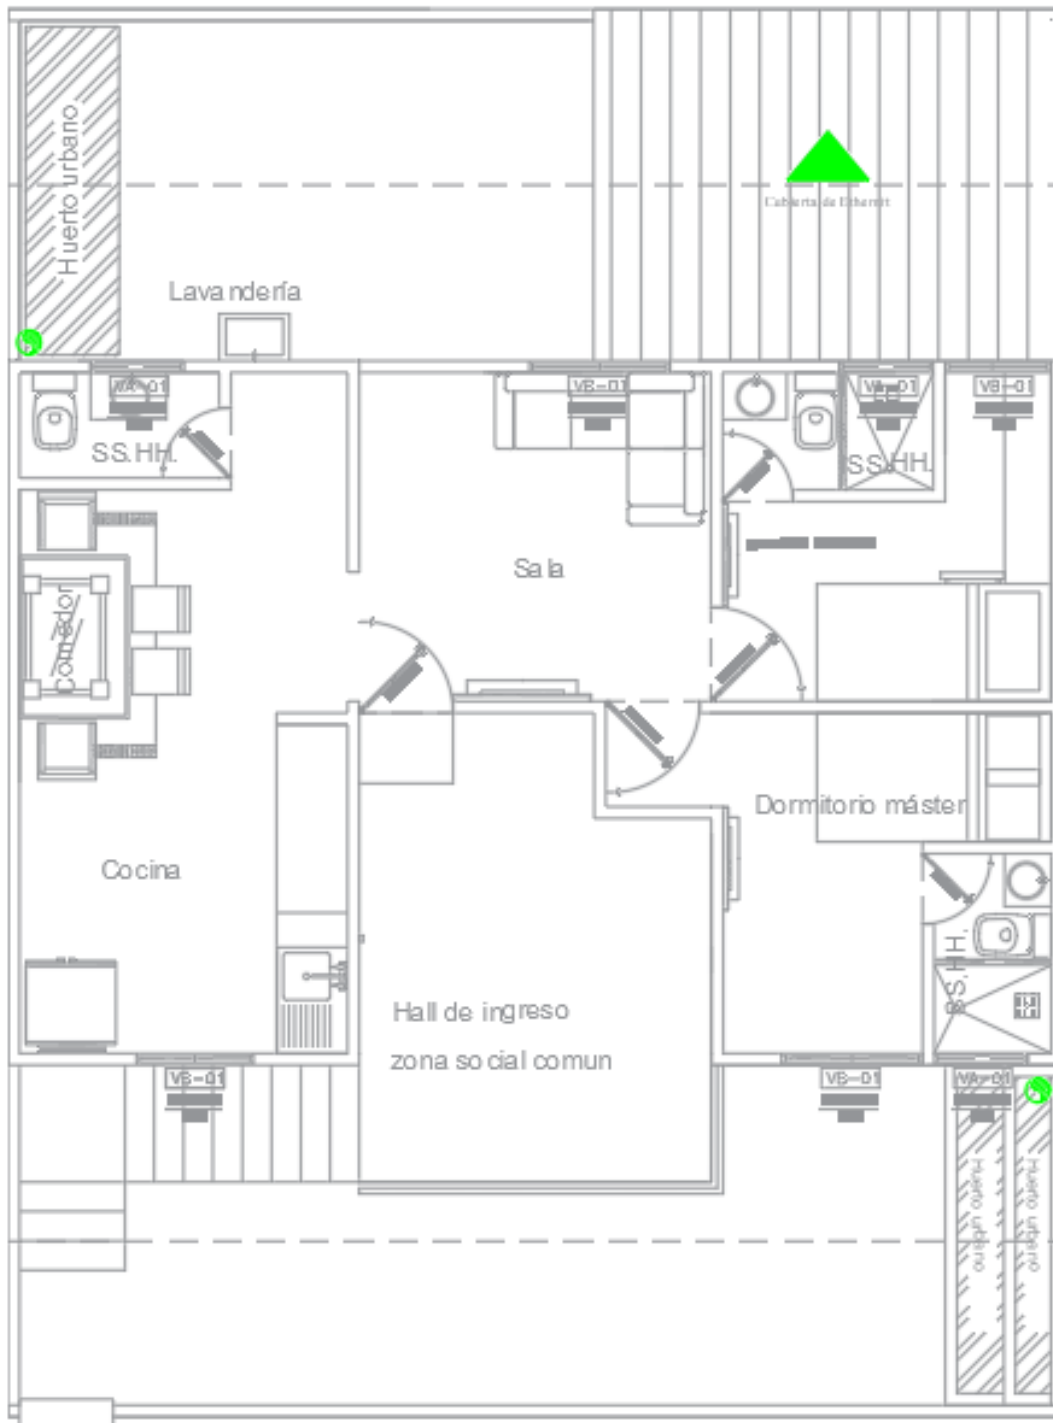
Plano bajantes de aguas lluvias planta baja
